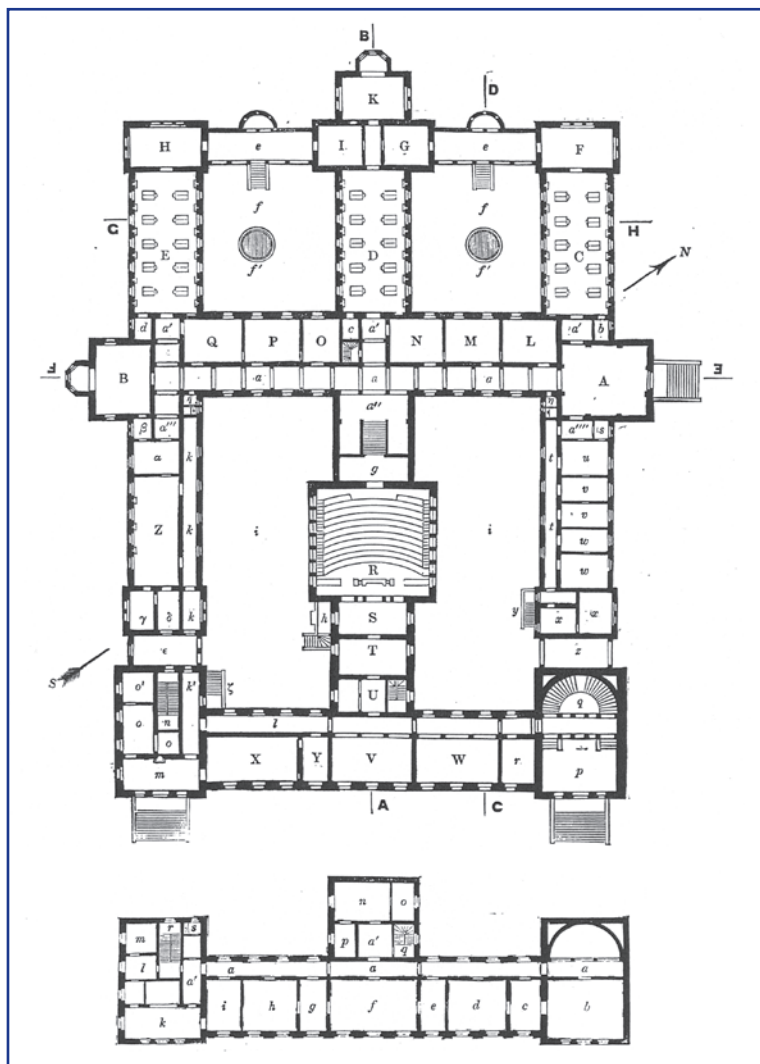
Grundriss des Erdgeschosses aus [5] (Erläuterungen im Text).
